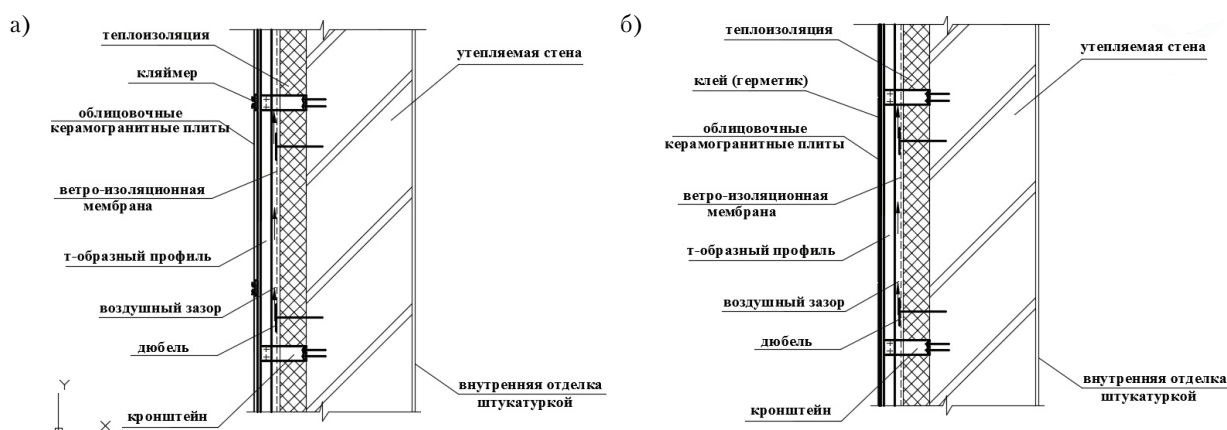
Навесной вентилируемый фасад с облицовкой керамогранитными плитами: а) видимое крепление на кляймерах; б) скрытое клеевое крепление.
